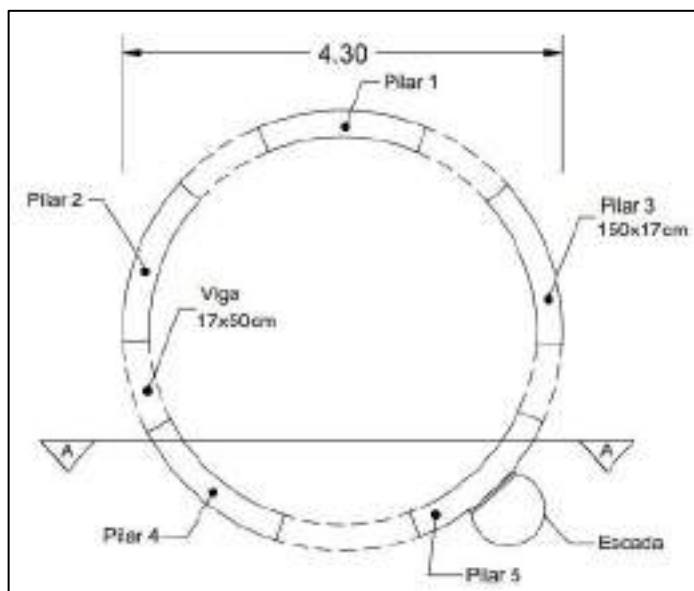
Levantamento métrico das dimensões do REL Agrovila, em planta
